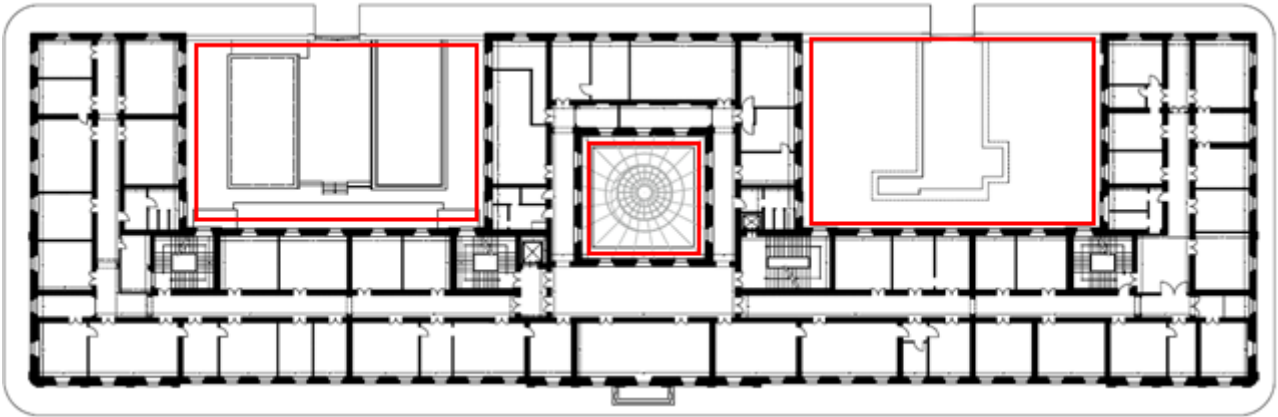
Pianta piano tipo con evidenziate le zone con elementi strutturali secondari
